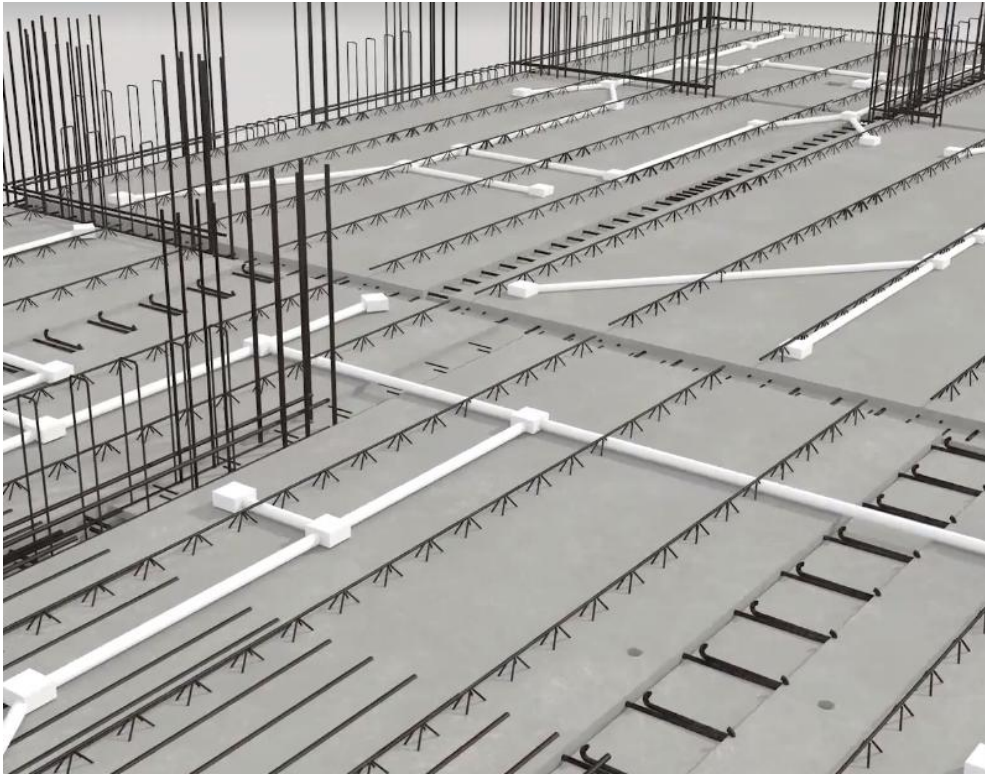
叠合楼板、上层墙体连接钢筋、线管安装
